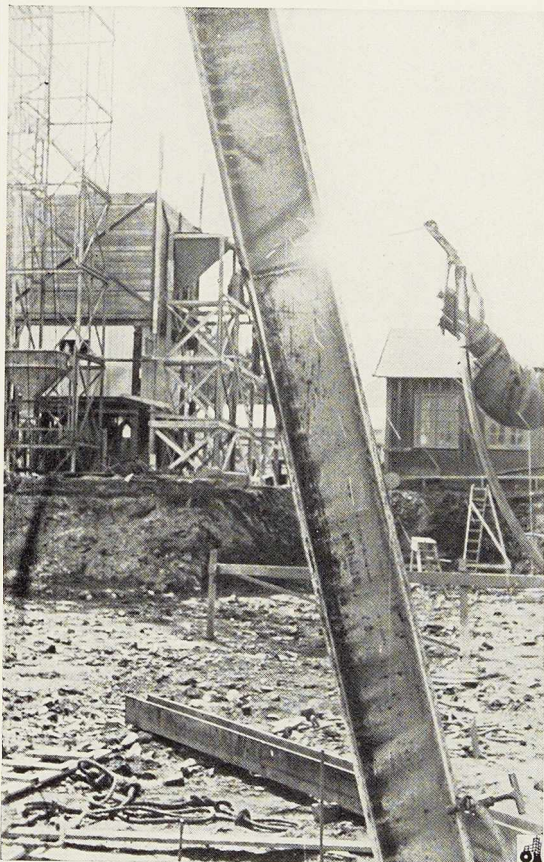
Assemblage par soudure de deux tronçons d'un pieu métallique, dont la longueur totale dépasse 16 mètres.
